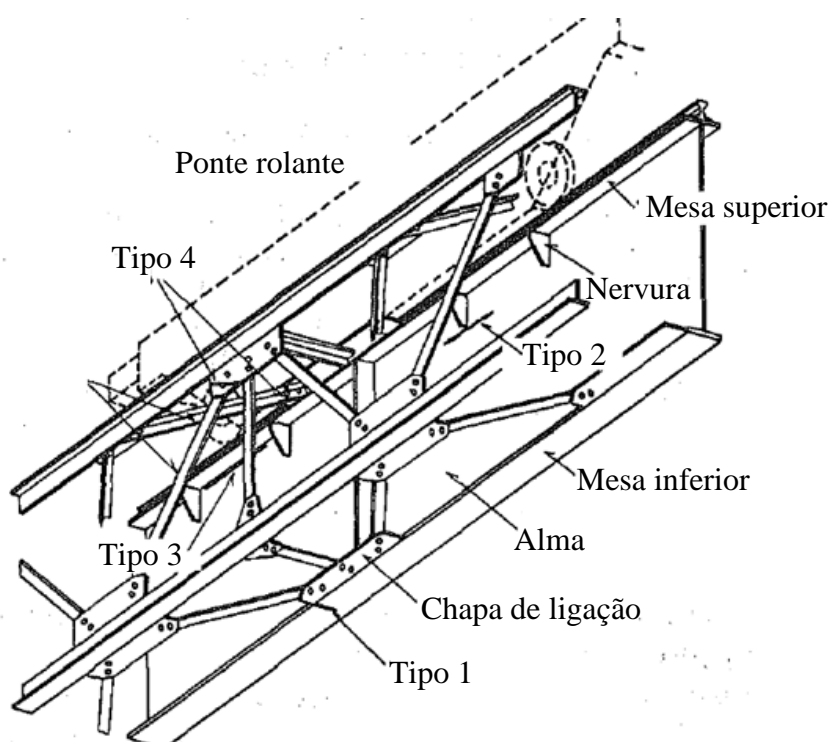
Tipos de trincas por fadiga em vigas de rolamento
